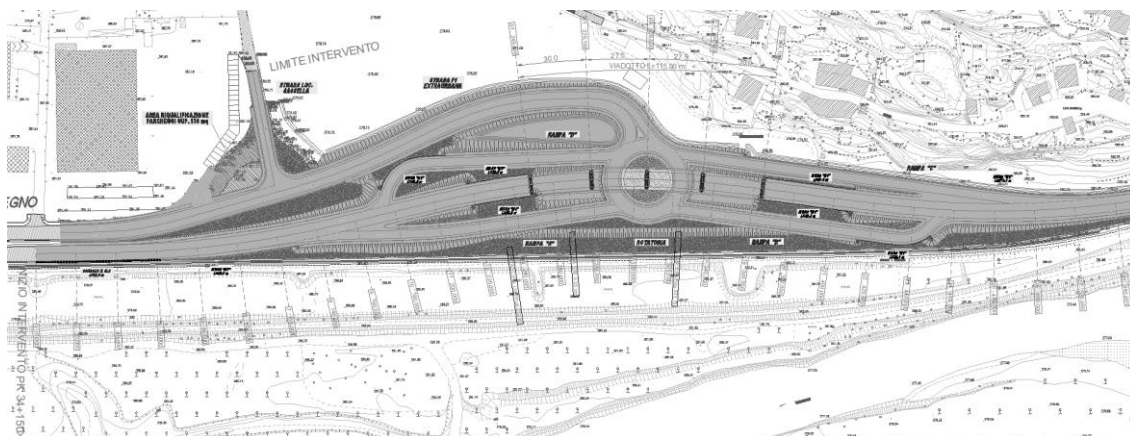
Planimetria del nuovo svincolo a livelli sfalsati
